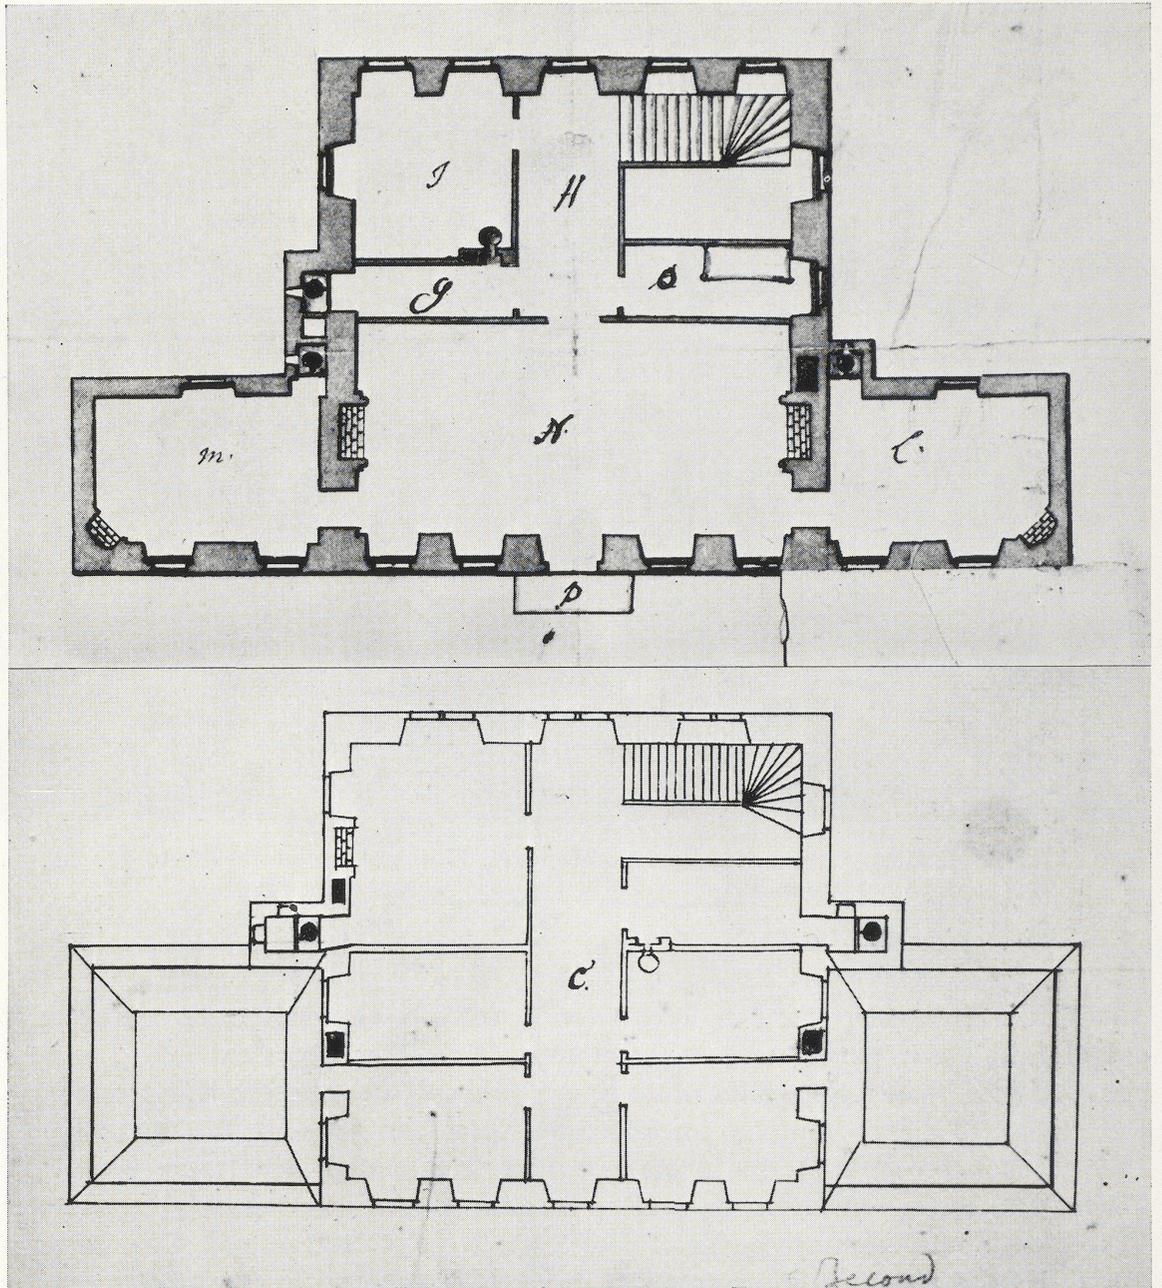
Bekond, Grundriß des Haupt- und Mezzaningeschosses, Entwürfe von Ravensteyn 1710 (P8, P10)
